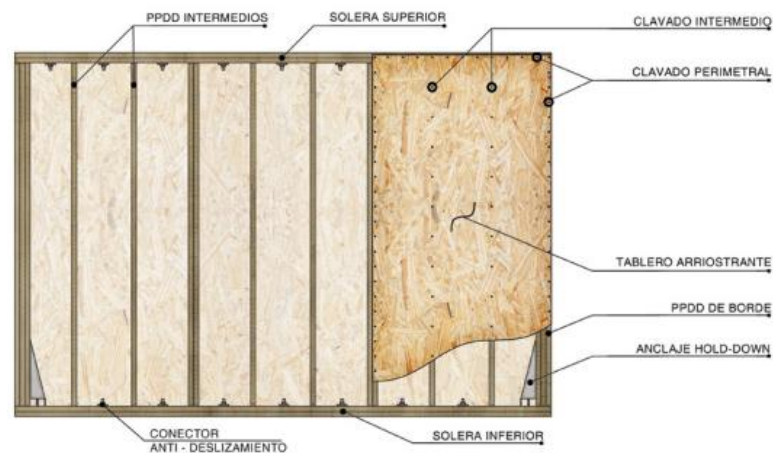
Ejemplo muro de corte con anclaje tipo Hold Down
